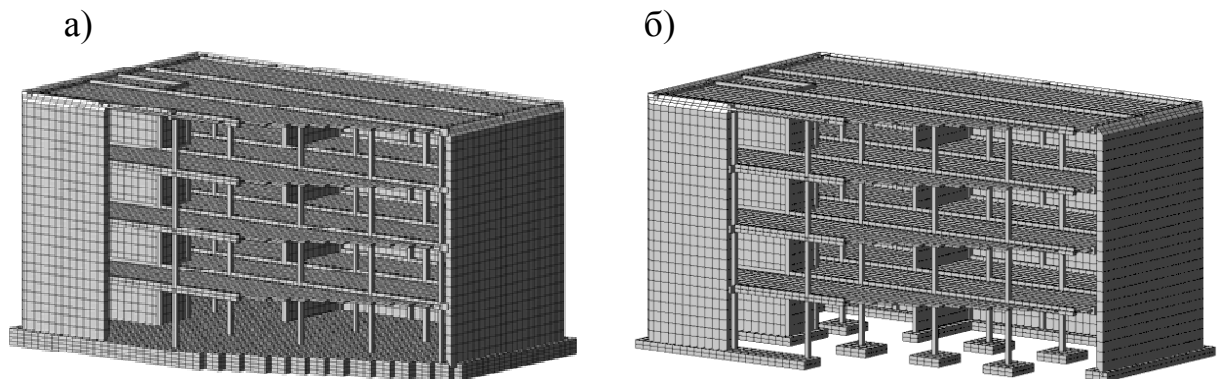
Скінченно-елементна розрахункова схема будівлі з плитним фундаментом (а) і з стрічковими і стовпчастими фундаментами (б)
